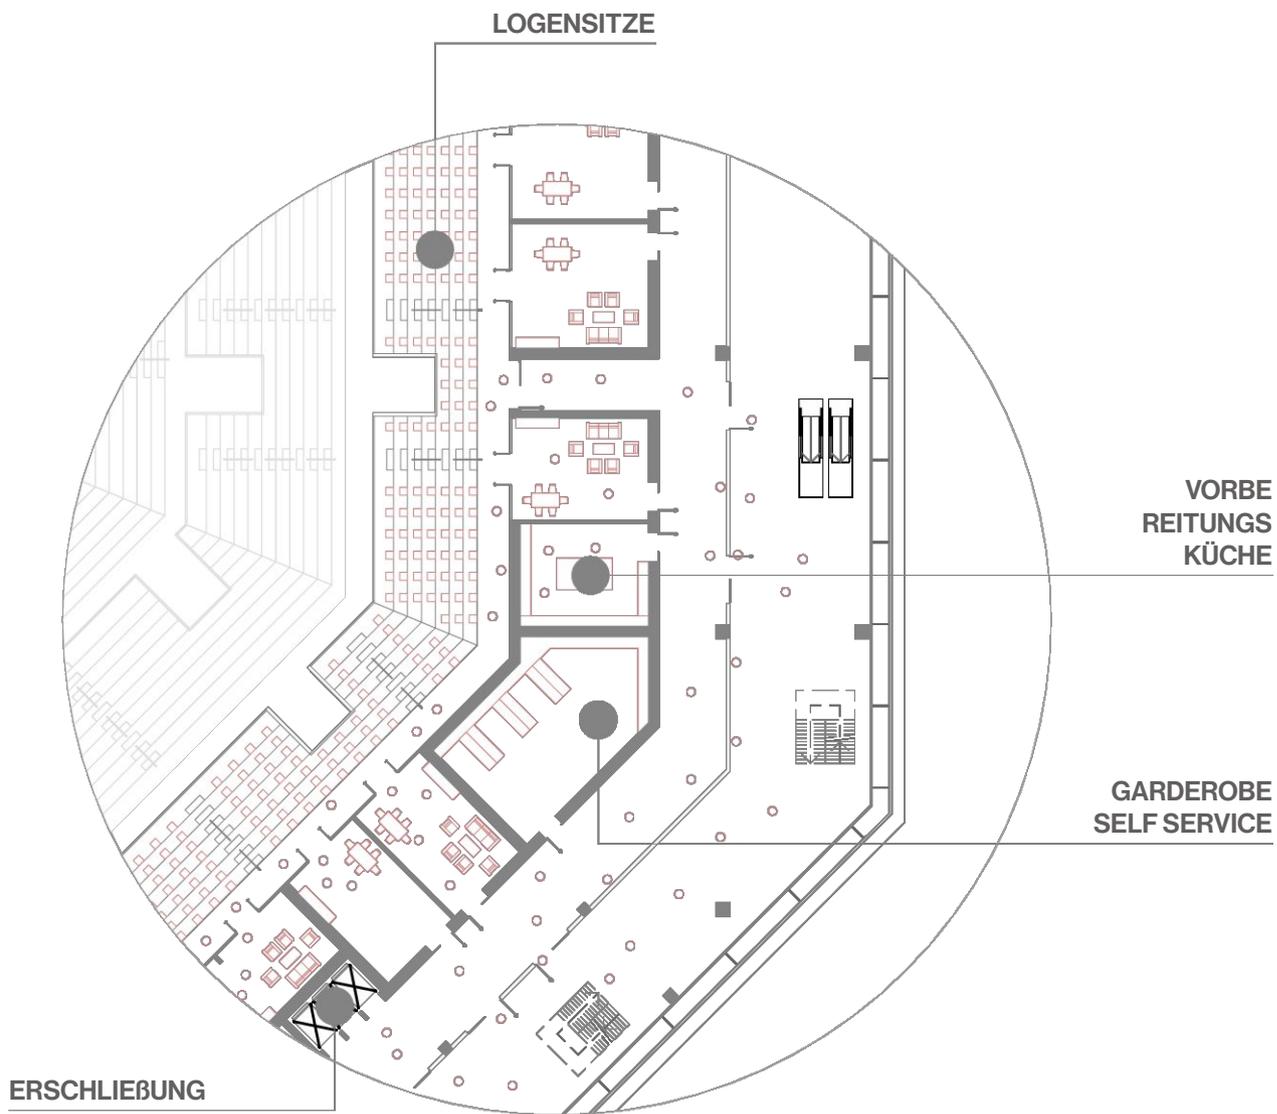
Grundriss 3. OG Zoom 2
